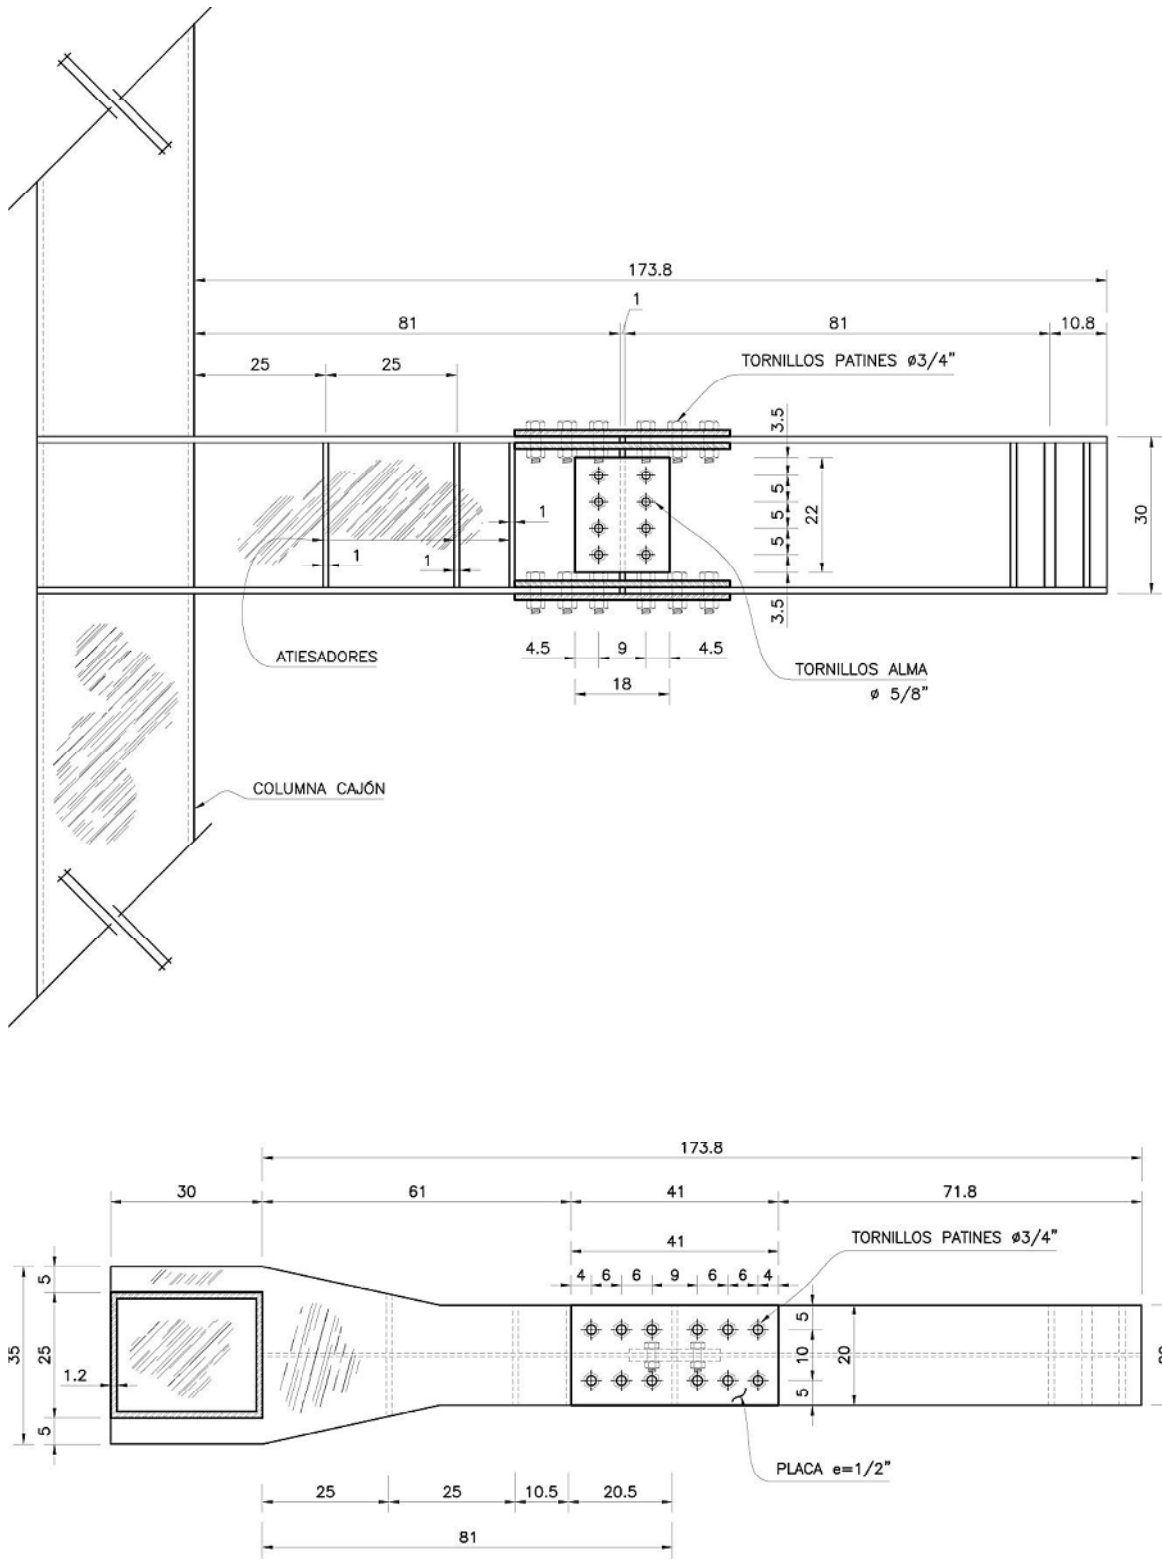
Conexión BFP7, vista en elevación y en planta
